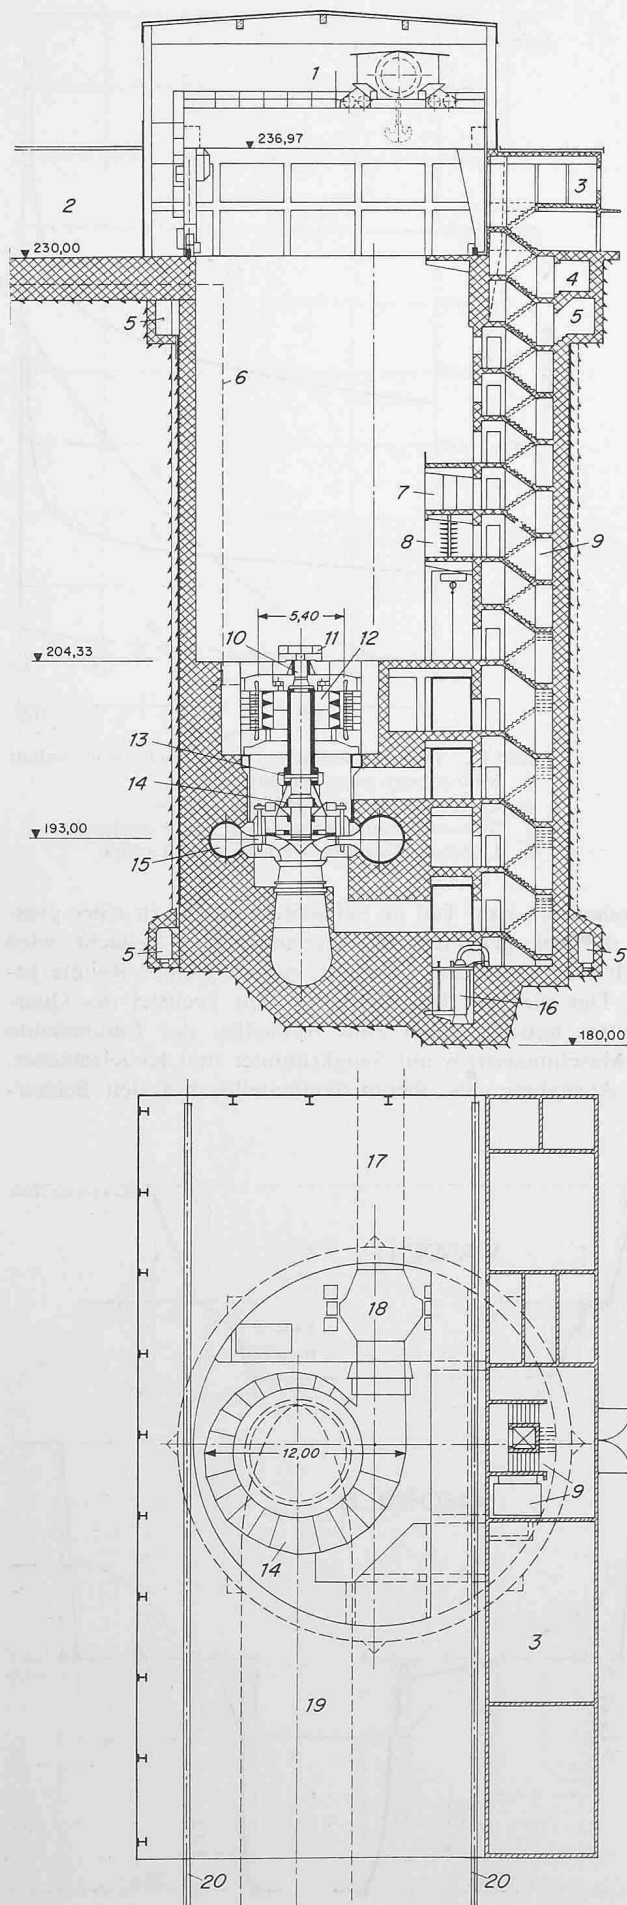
Schachtkraftwerk und Montagehalle, Vertikalschnitt und Grundriss 1:500
